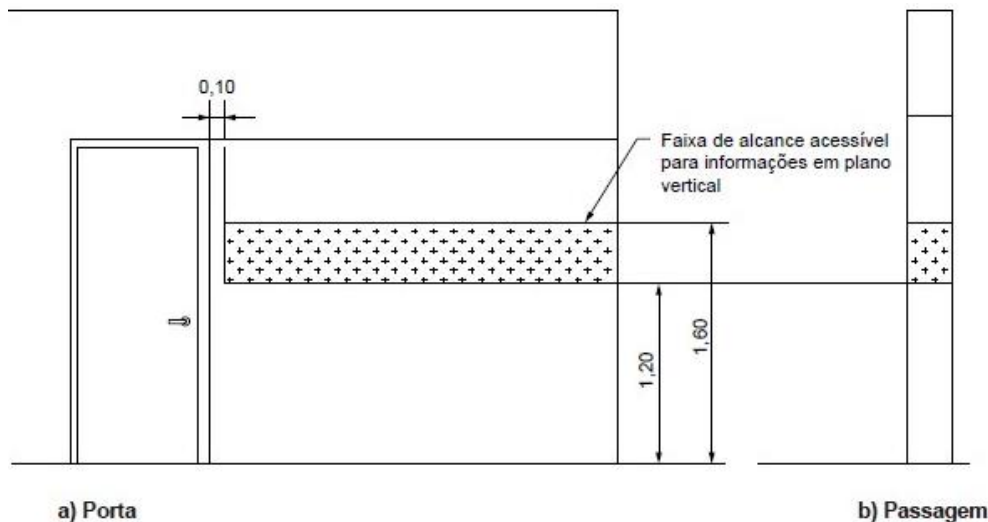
Sinalização de portas e passagens – Faixa de alcance acessível
